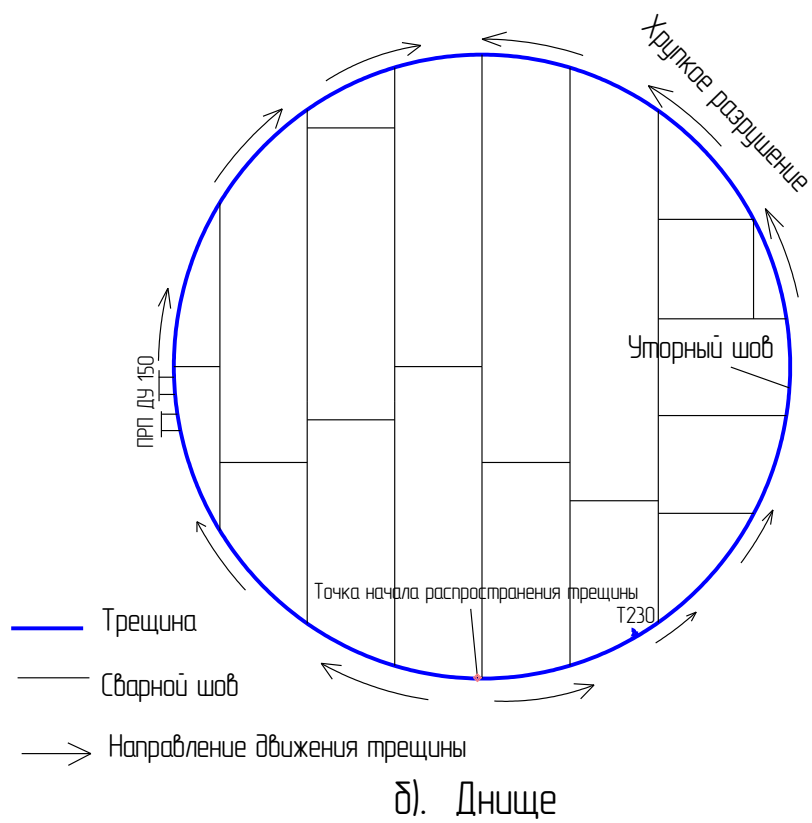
Схема разрушения резервуара РВС-700 №49, вид сверху
